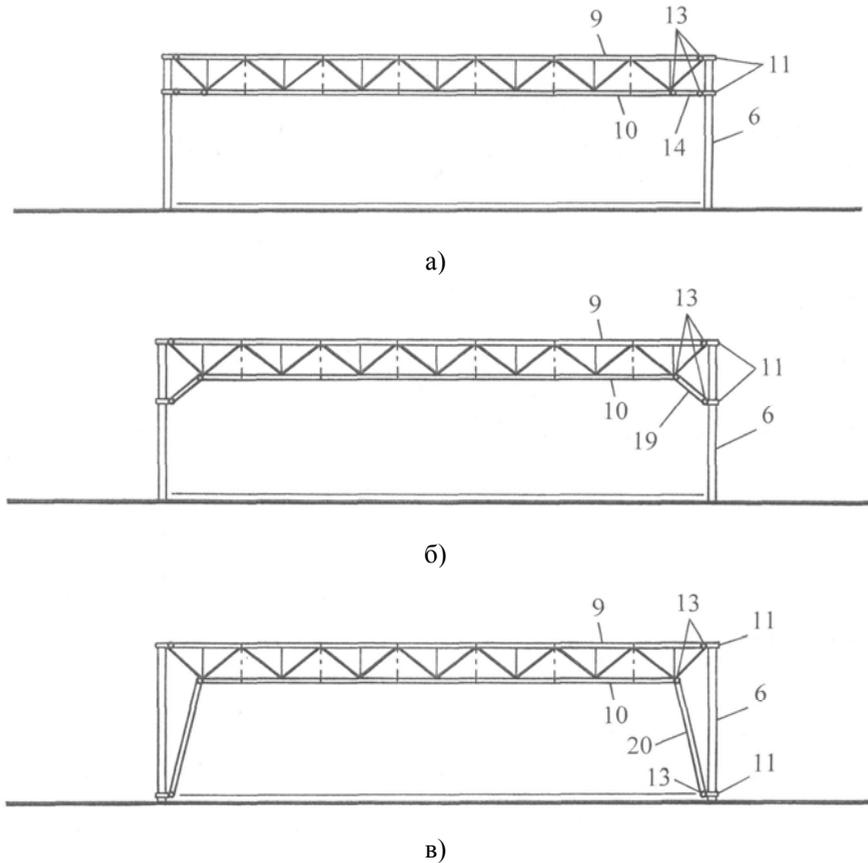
Схемы пространственного покрытия из перекрестной системы:
